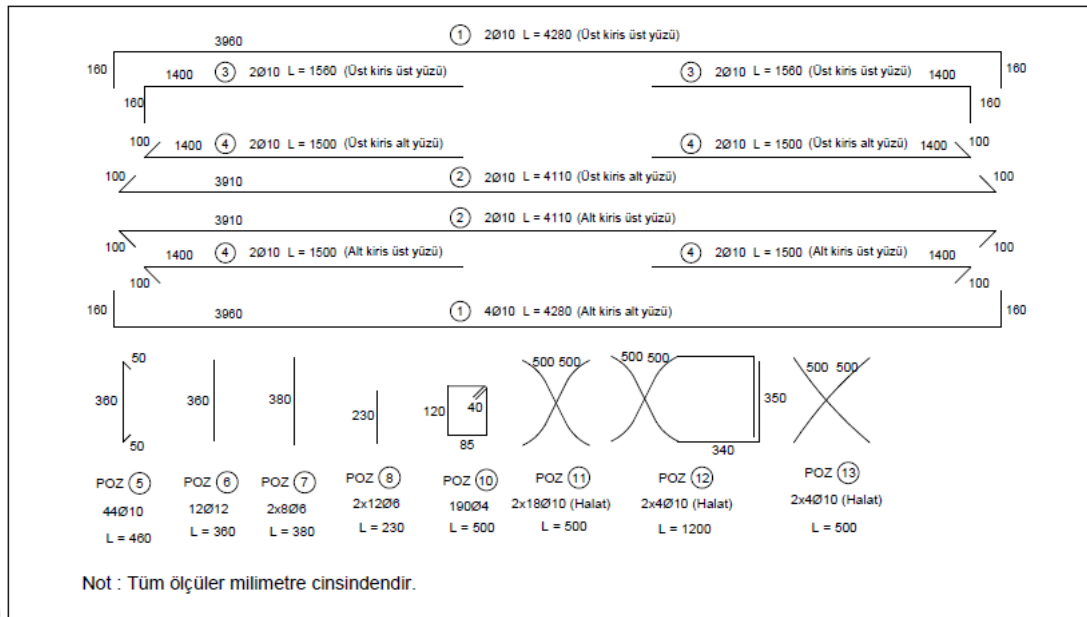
RBb Kirişi kiriş donatı Planı ve Kesitleri
